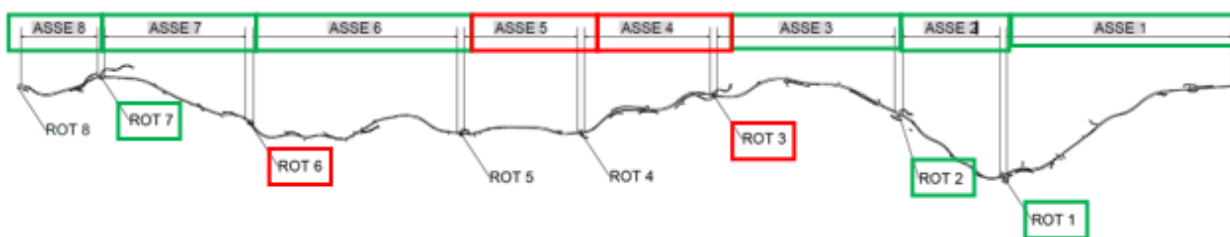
FASE 4 DI CANTIERIZZAZIONE
